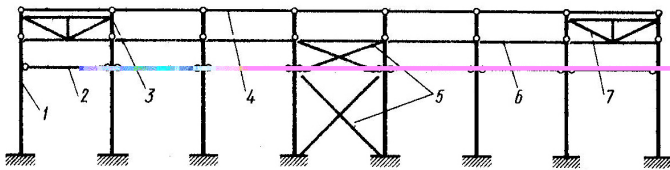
Продольная рама каркасного здания: 1 – колонна; 2 – подкрановая балка; 3 – балка покрытия; 4 – плита покрытия; 5 – вертикальные связи по колоннам; 6 – распорки; 7 – вертикальные связи покрытия
